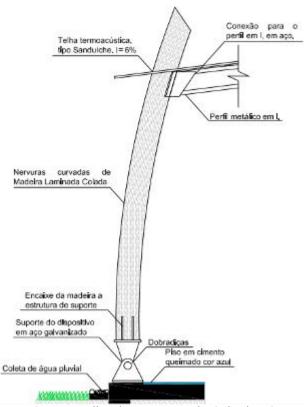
Detalhe da estrutura da Sala das Canoas em Madeira Laminada Colada. Fonte: Acervo Próprio (2014).
